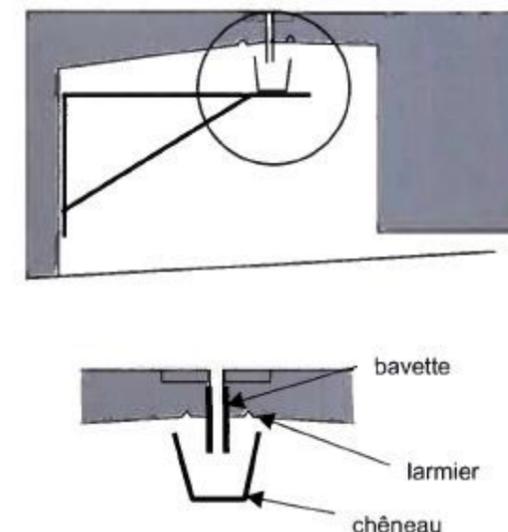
Principe de fixation des chéneaux sous joints de chaussées
